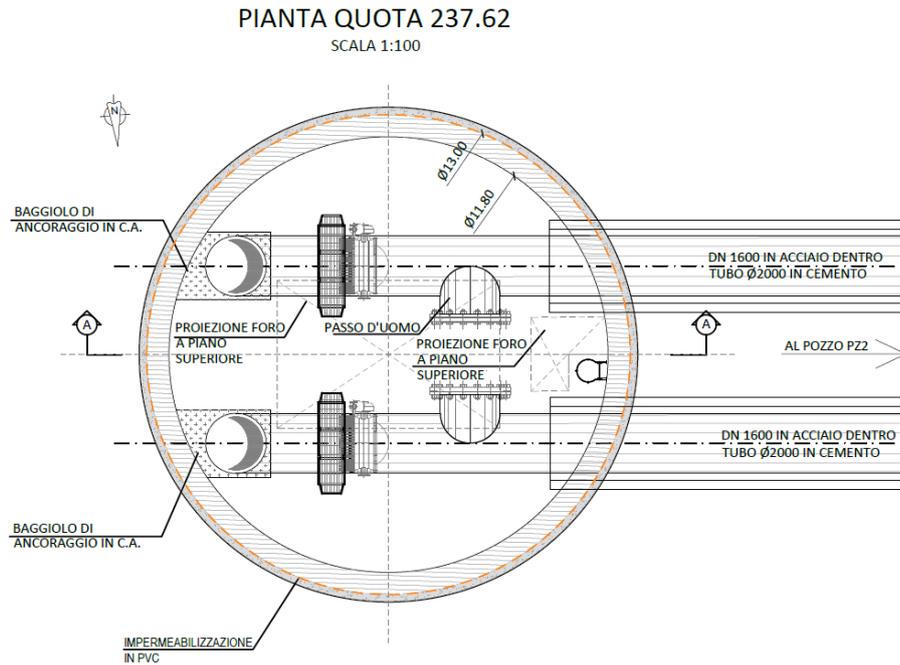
Rappresentazione in pianta del manufatto PZ1
